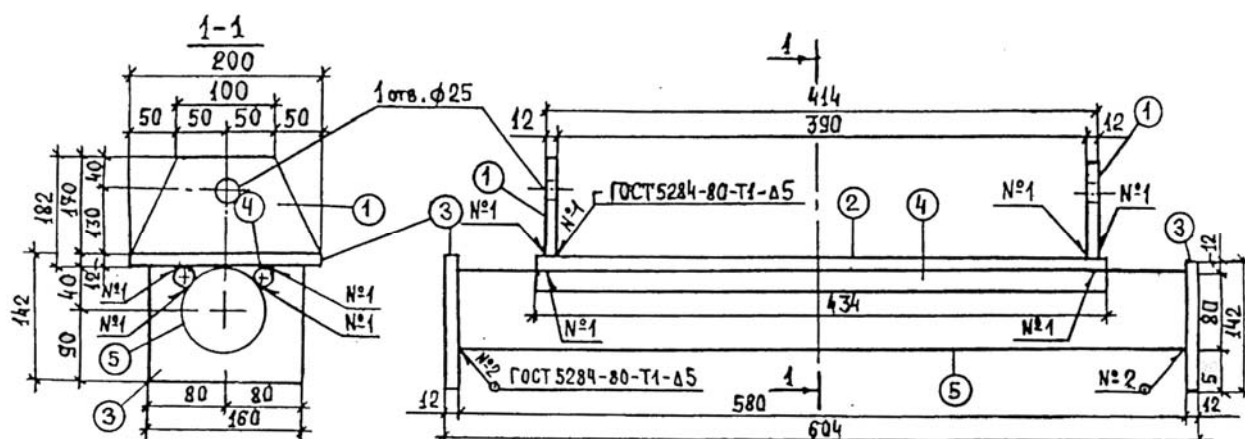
Конструкция отгибающего устройства для усиления предварительно напряженных балок по выпуску 122-63 Союздорпроекта четырьмя пучками из одиночных арматурных канатов. 1- ребро; 2 – втулка; 3 – палец; 4 – основание
